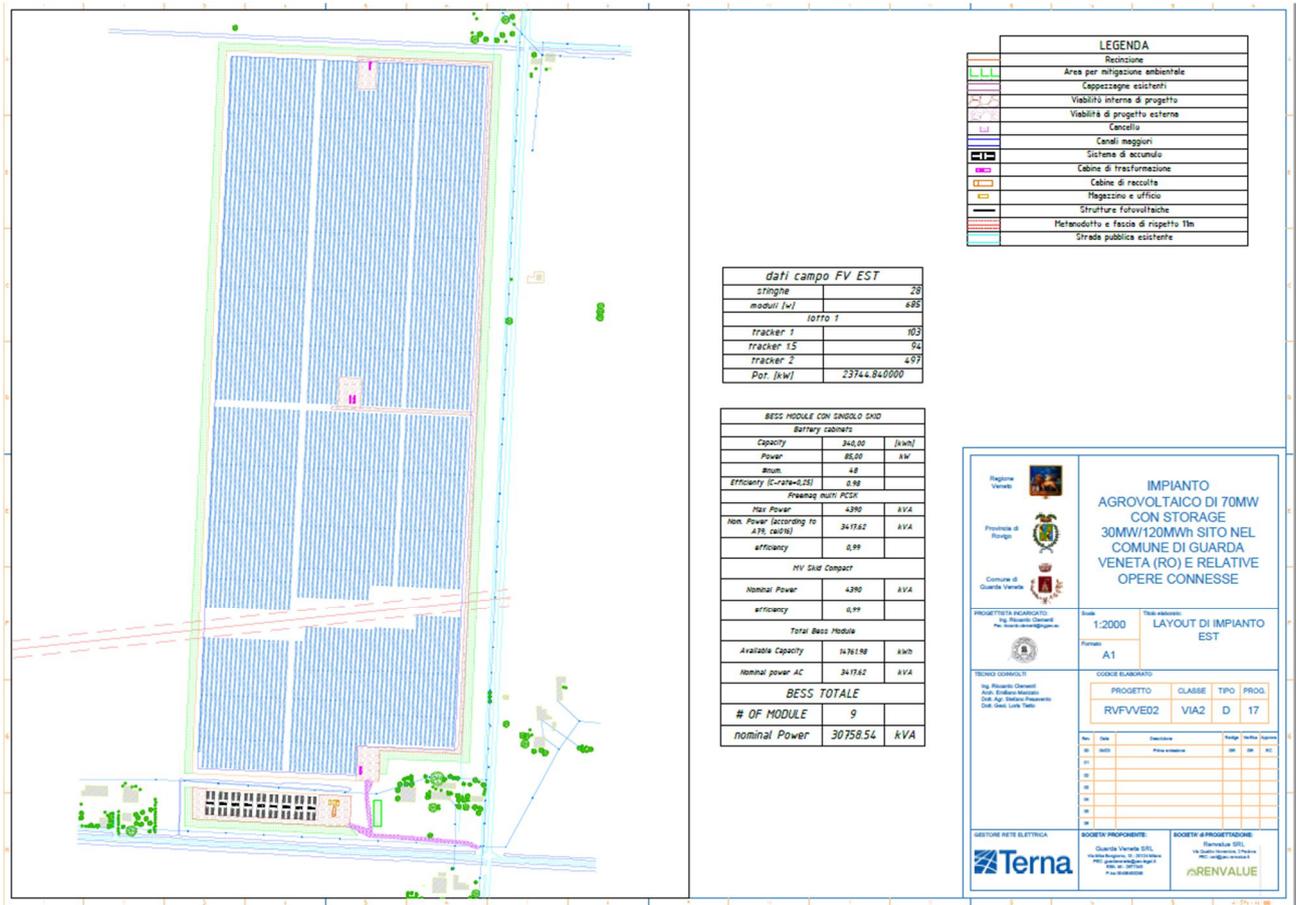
Layout dell'impianto agrivoltaico – Lotto Est
